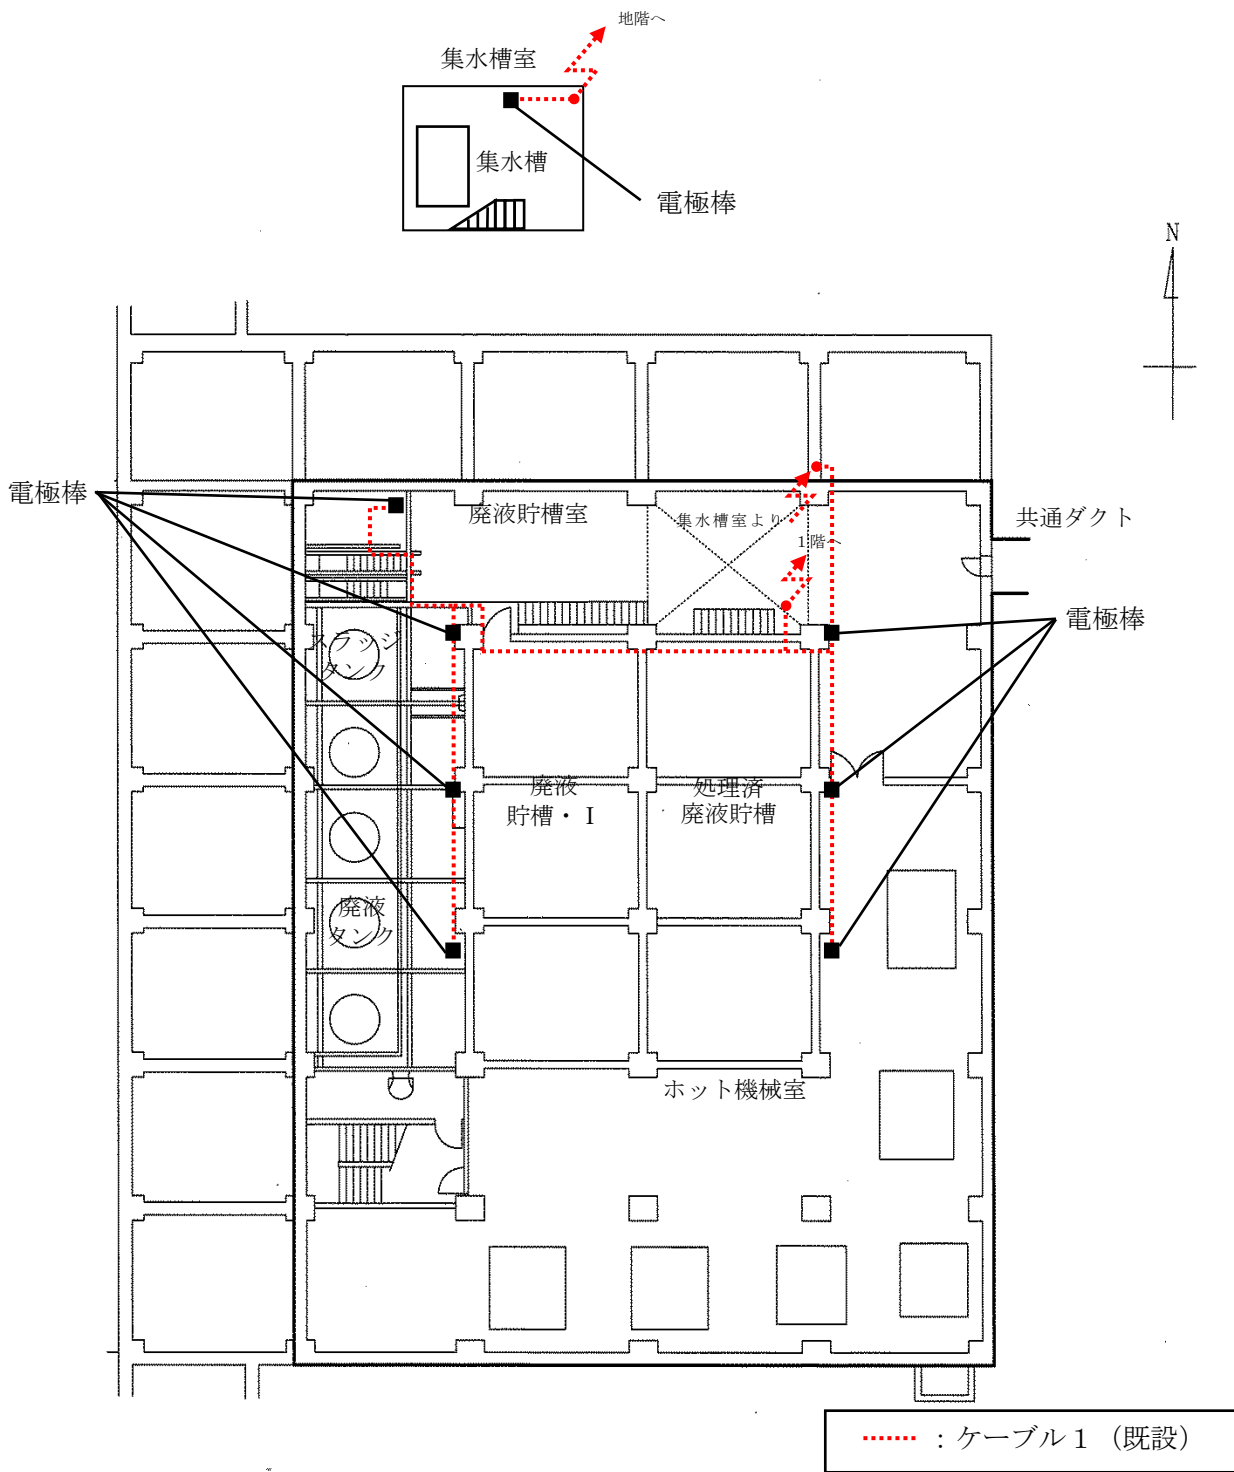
(2/2) 第2廃棄物処理棟の電極棒の配置図
